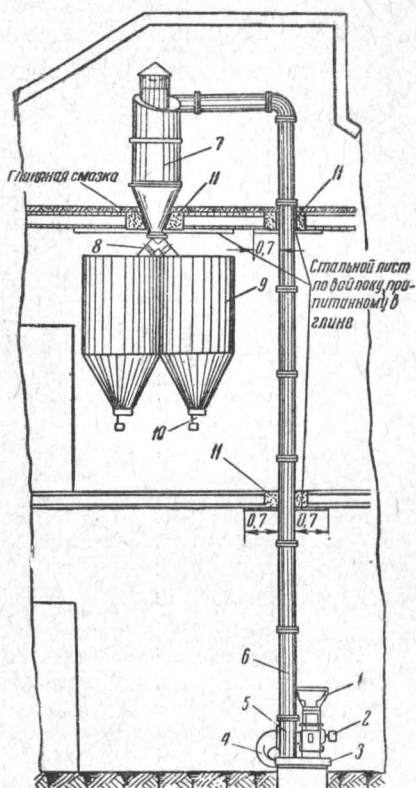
Схема установки молотковой дробилки ДММ-0,3 с вентилятором:
